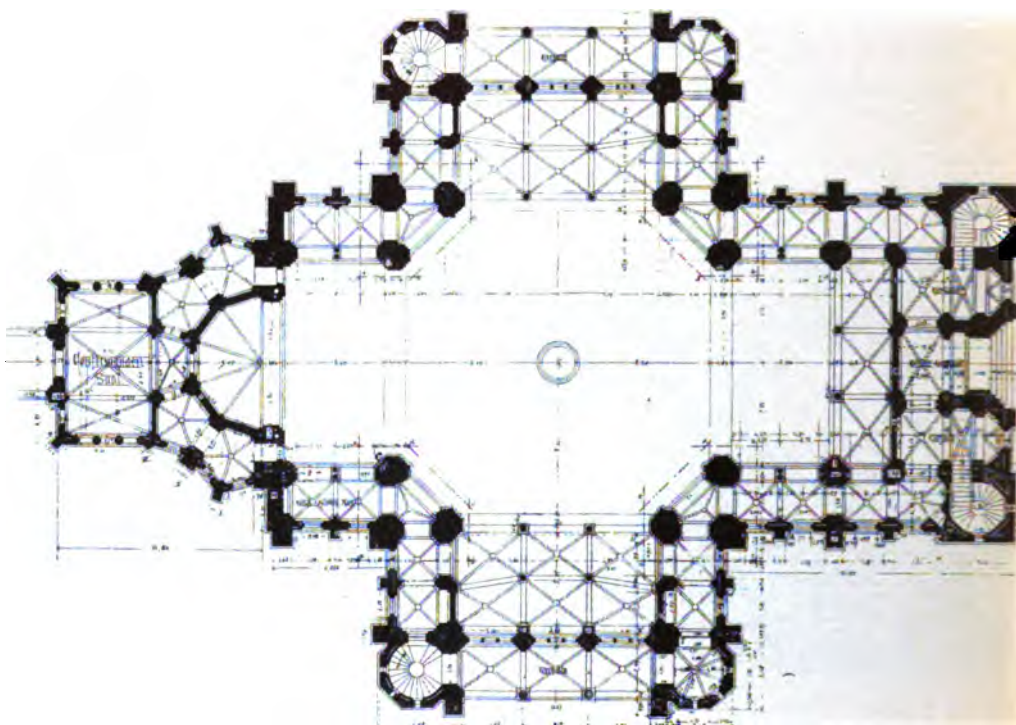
Joh. Döberlein: Kirche zum heil. Kreuz, Berlin. Grundriß.
